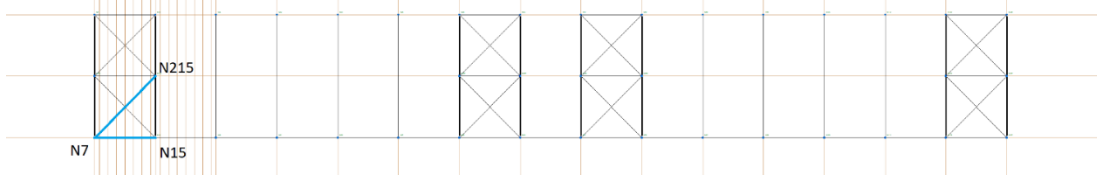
Nudos y vigas elegidos del arriostramiento lateral.
